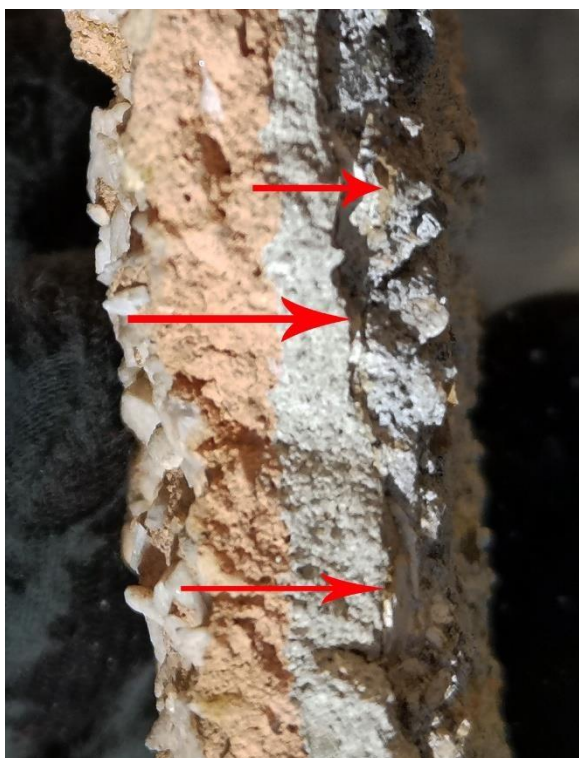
Elewacja wieży, widok z góry, równoległe do powierzchni elewacji.
